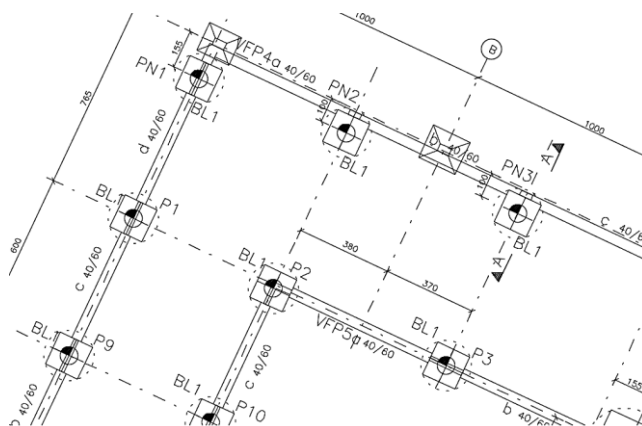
Planta ilustrativa da solução de fundações indiretas
